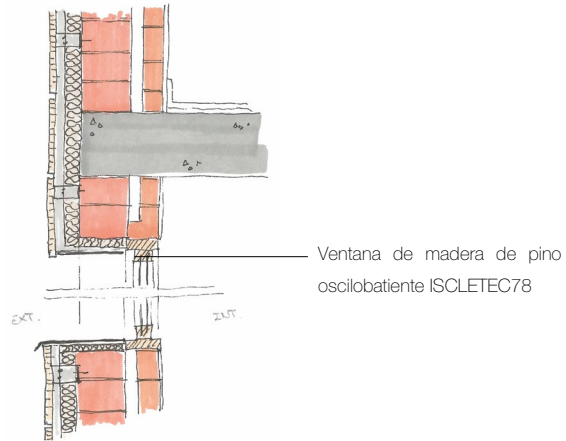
Detalle constructivo del hueco de ventana con aislamiento por el exterior (fachada ventilada) (autoría propia).
